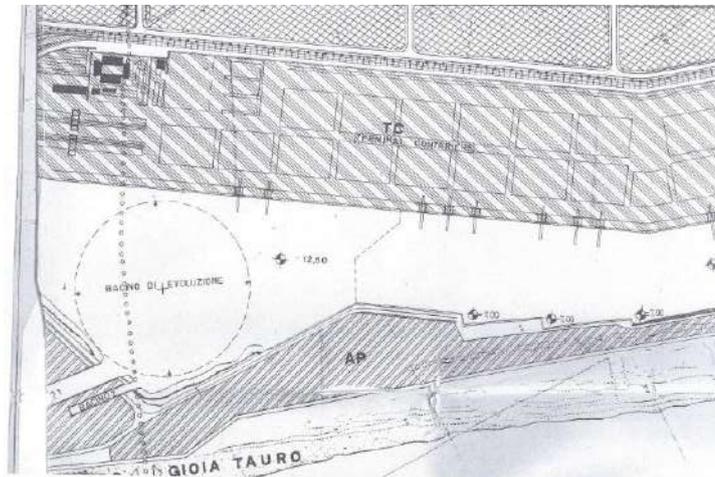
Stralcio di PRT approvato nel 1997 inerente le banchine di progetto
